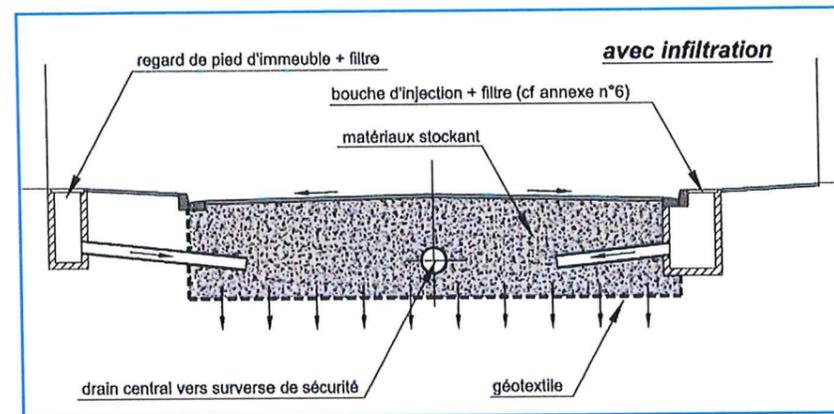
Structure à chaussée réservoir avec une évacuation par infiltration ((Source : CETE Nord - Picardie)
